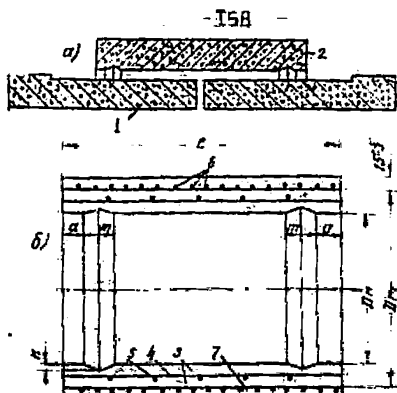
Лестный стык в железобетонных трубах (а - деталь стыка трубы; б - продольный разрез муфты): 1 - железобетонная труба; 2 - железобетонная муфта; 3 - железобетонный сердечник муфты; 4 - продольная предварительно напряженная арматура сердечника муфты; 5 - поперечная арматура сердечника; 6 - предварительно напряженная спиральная арматура; 7 - защитный бетонный слой
